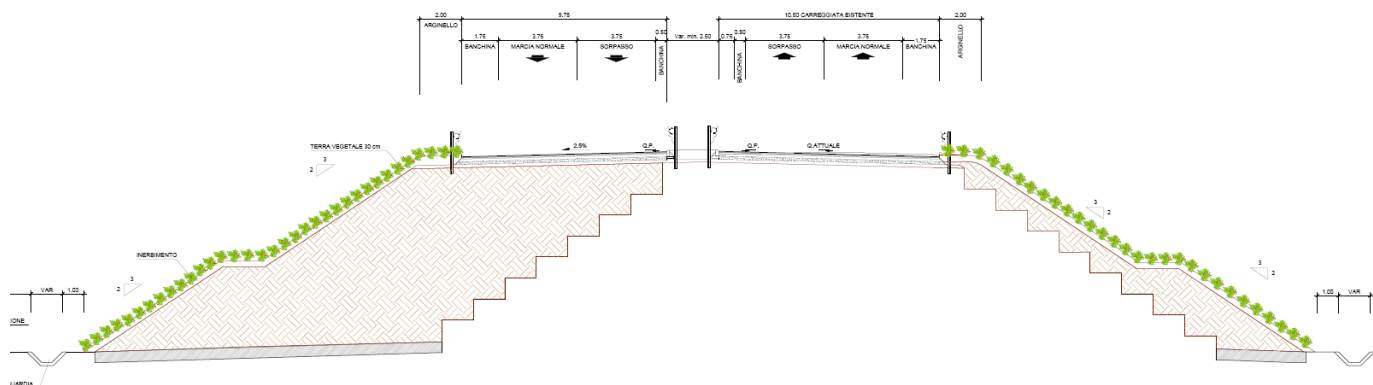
Interventi di mitigazione su sezione tipo in rilevato
